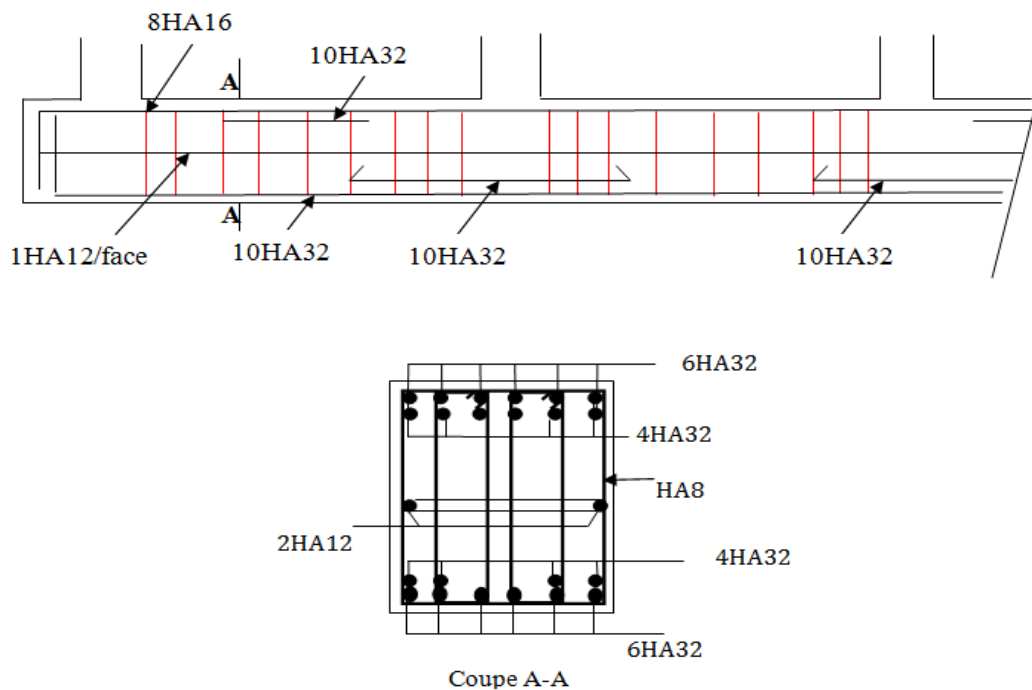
Schéma de ferrailage de la poutre de rigidité.
